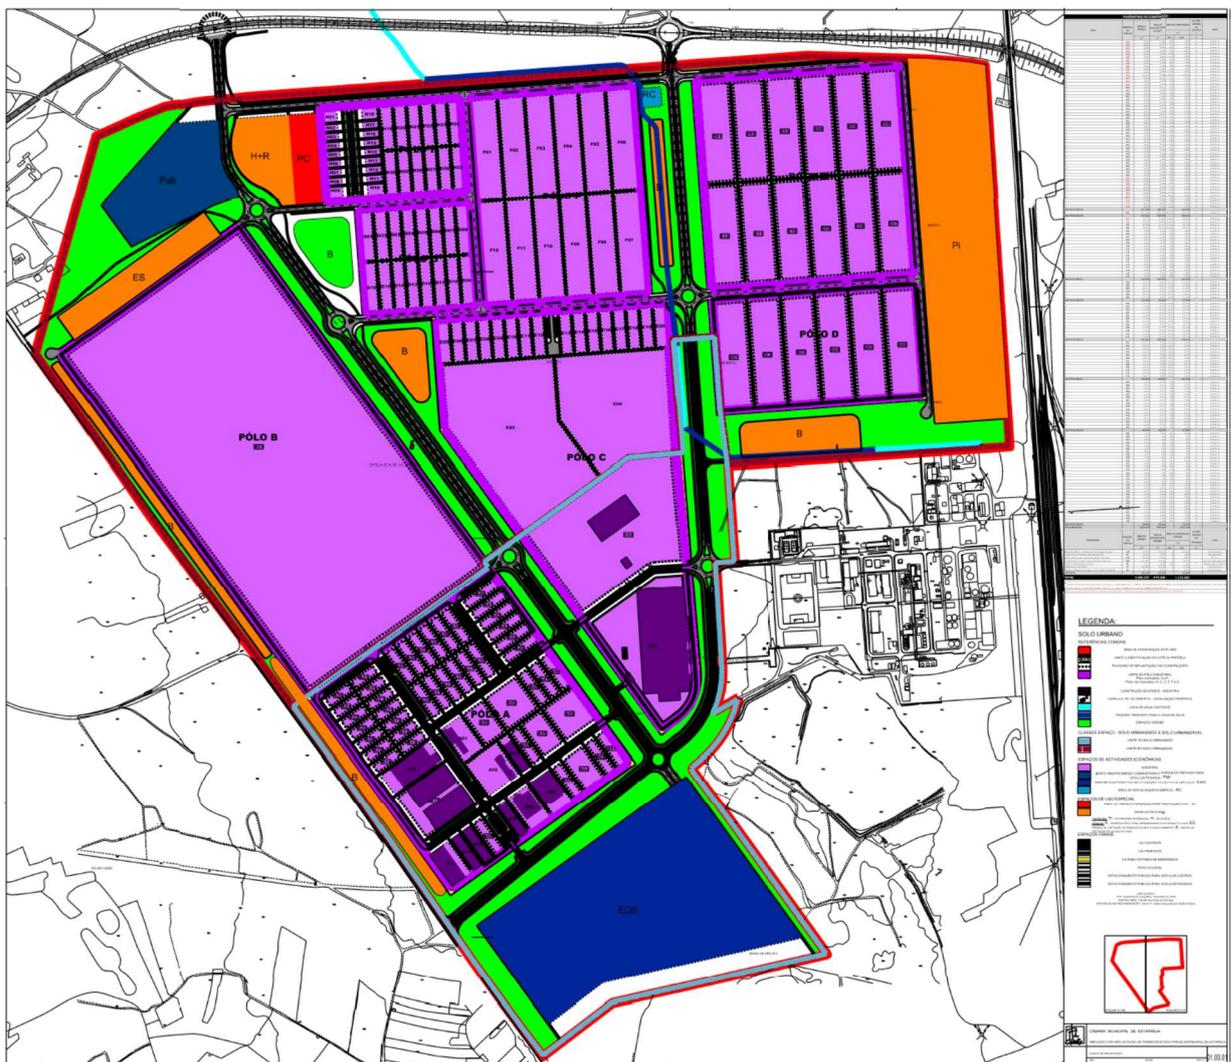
Estrutura de Ordenamento do PPEEE em vigor (Composição das Plantas de Implantação)
